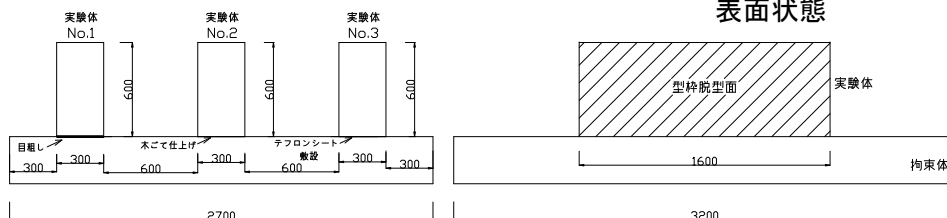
実験体と拘束体の形状寸法(左:断面図, 右:側面図)
